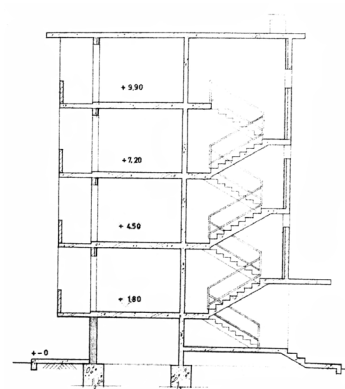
Plano de la sección transversal de la edificación situada en la Rúa Moaña-Coia, 5 (fotografía de autoría propia).
